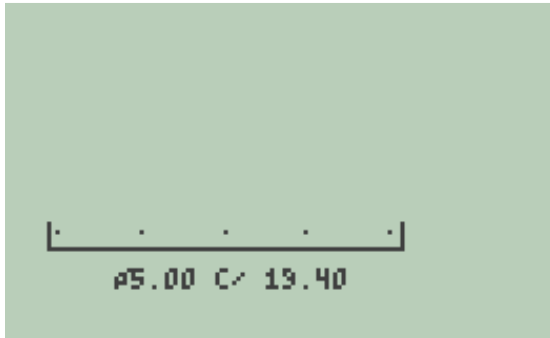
Sapata corrida sem viga de rigidez - Detalhamento da armadura transversal.
